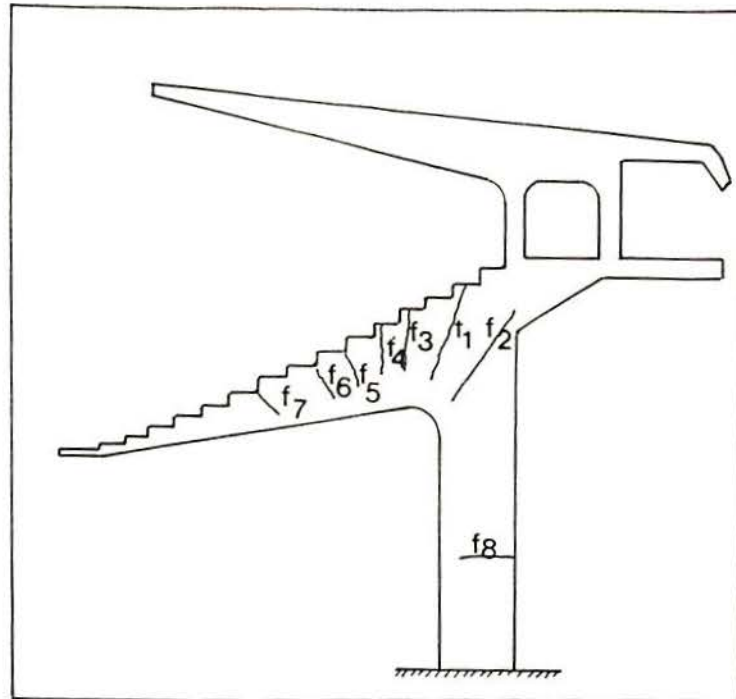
Esquema de fissuras no pórtico 2 para 16 KN.
